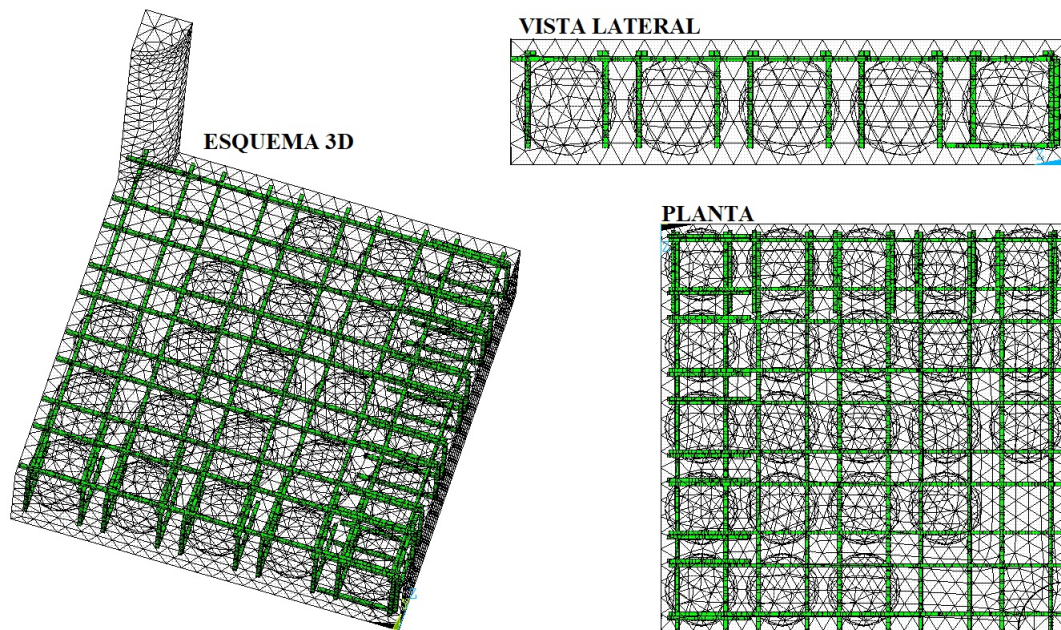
Elementos de reforço REINF264 no interior do concreto
